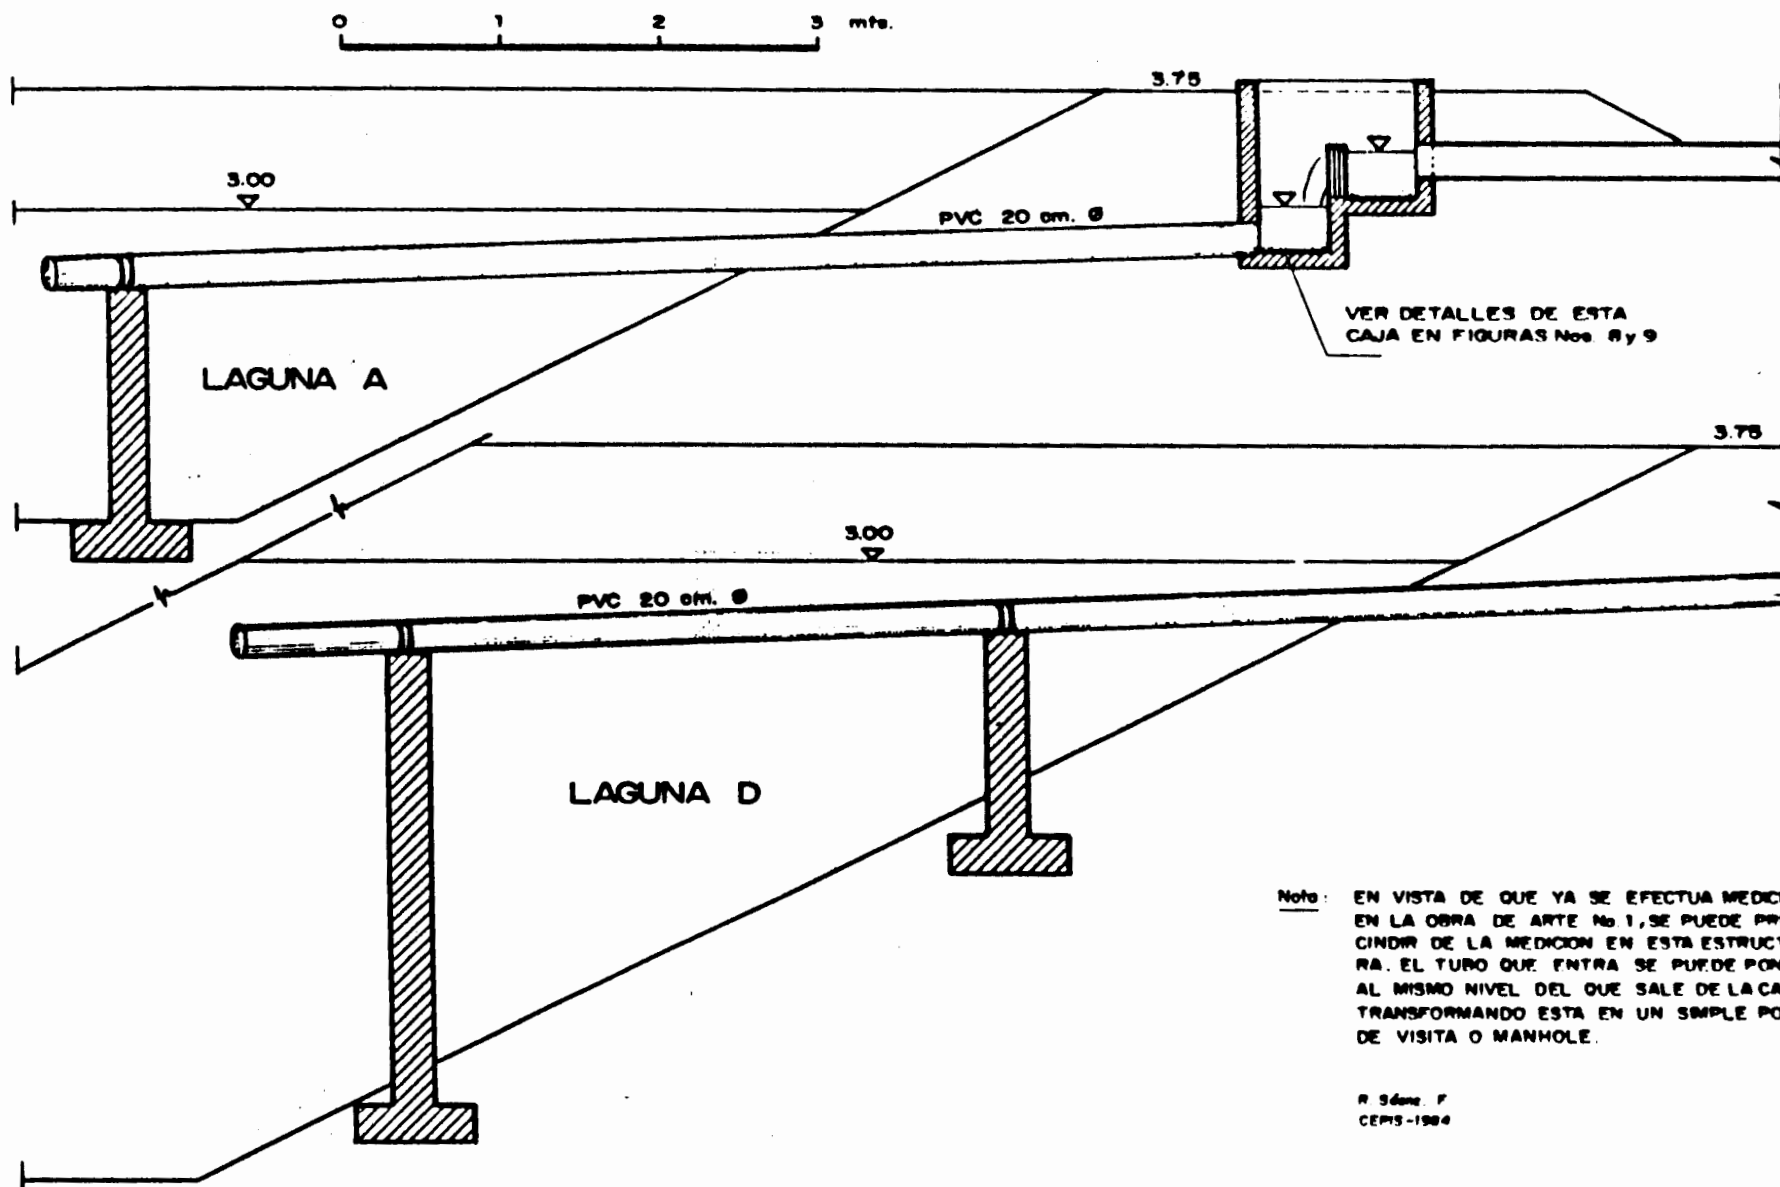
DETALLE DE LAS ESTRUCTURAS DE ENTRADA - OBRAS DE ARTE Nos. 2 y 6
